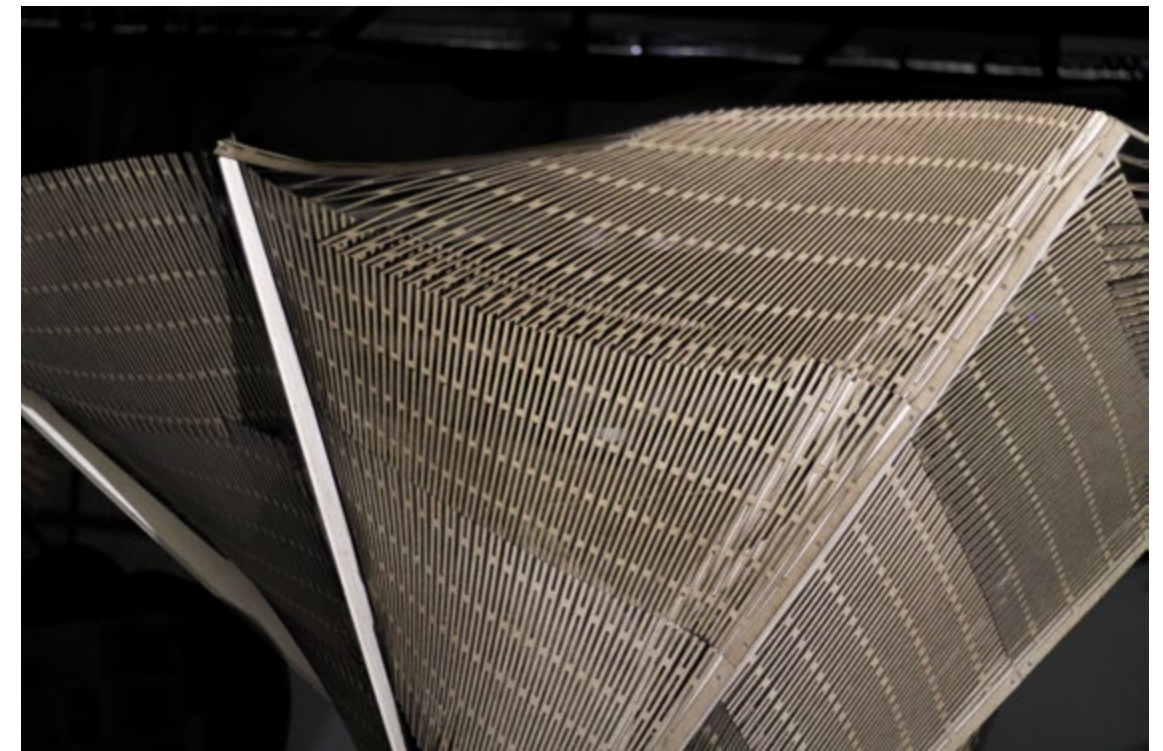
finální digitální verze prvního prototypu perspektivní pohled
